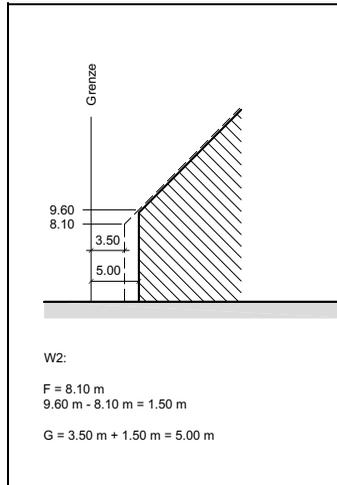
Grenzabstand eines abgerundeten Baukörpers
